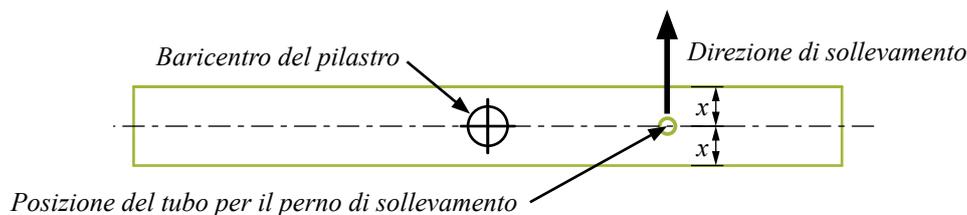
Installazione del tubo per il perno di sollevamento sopra il baricentro.
